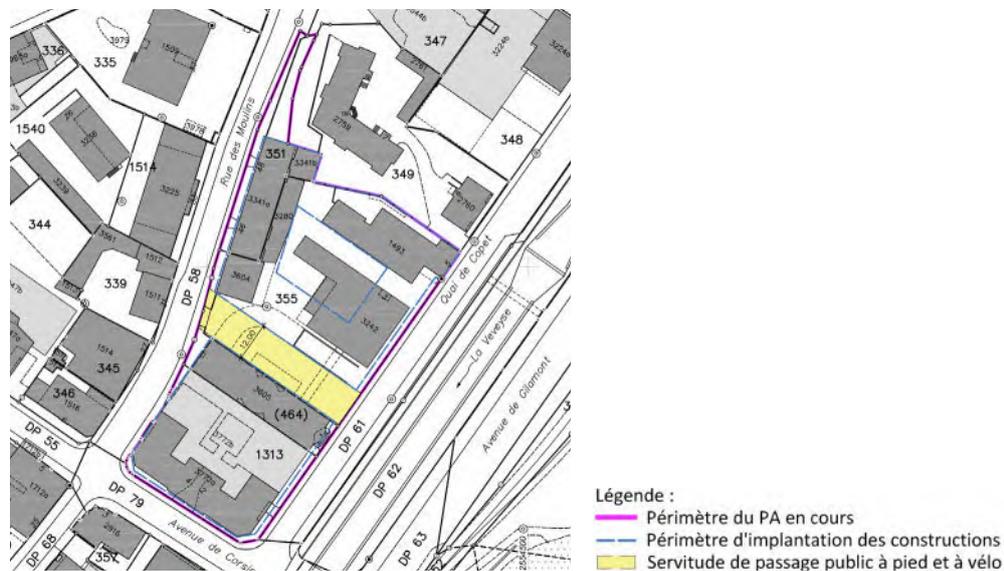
Plan de la nouvelle servitude de passage (source: Gemetris)
